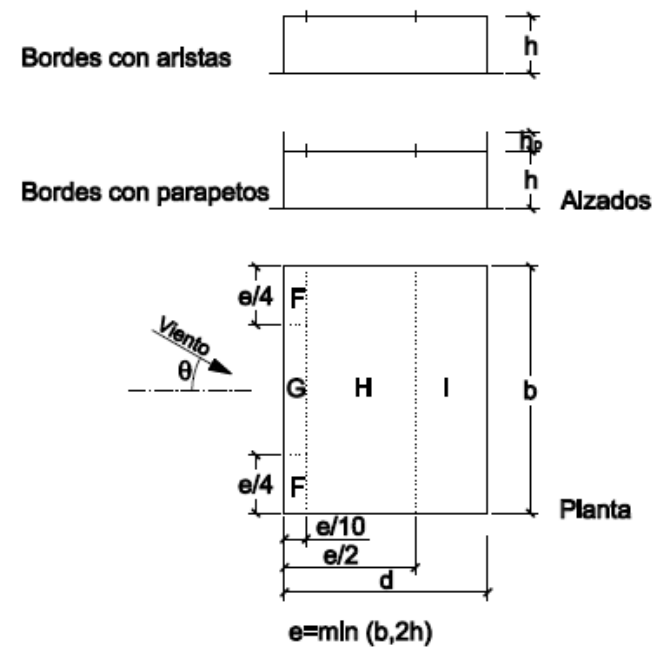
Zonas de acción del viento para una cubierta plana. (DBSE-AE del CTE)
